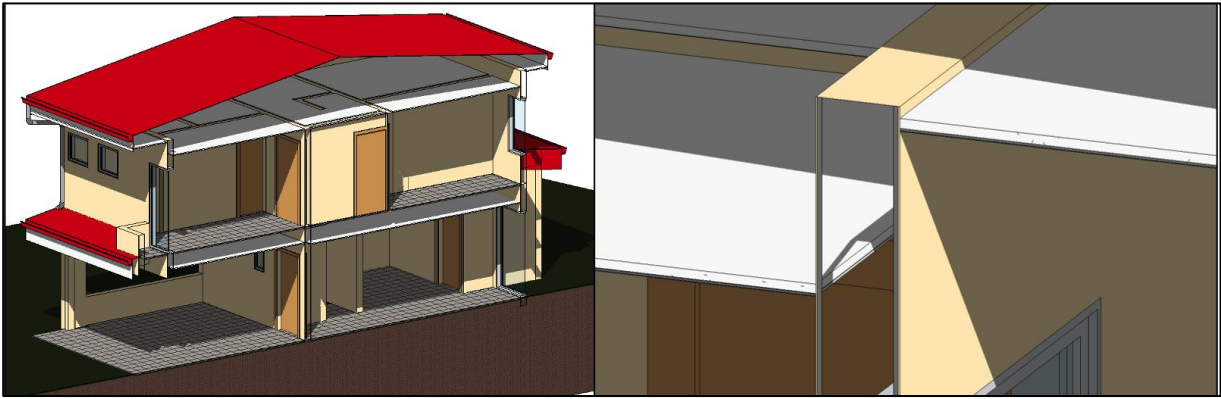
Vista en corte de detalles Modelo BIM Arquitectónico del proyecto seleccionado
